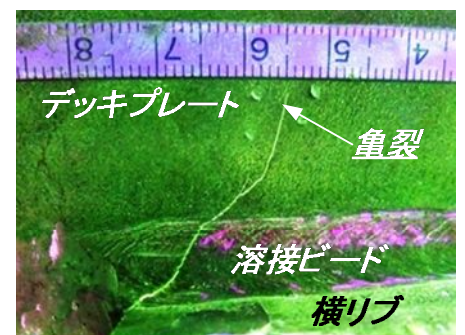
亀裂進展状況 (リブ 1, スリット上部北側)
